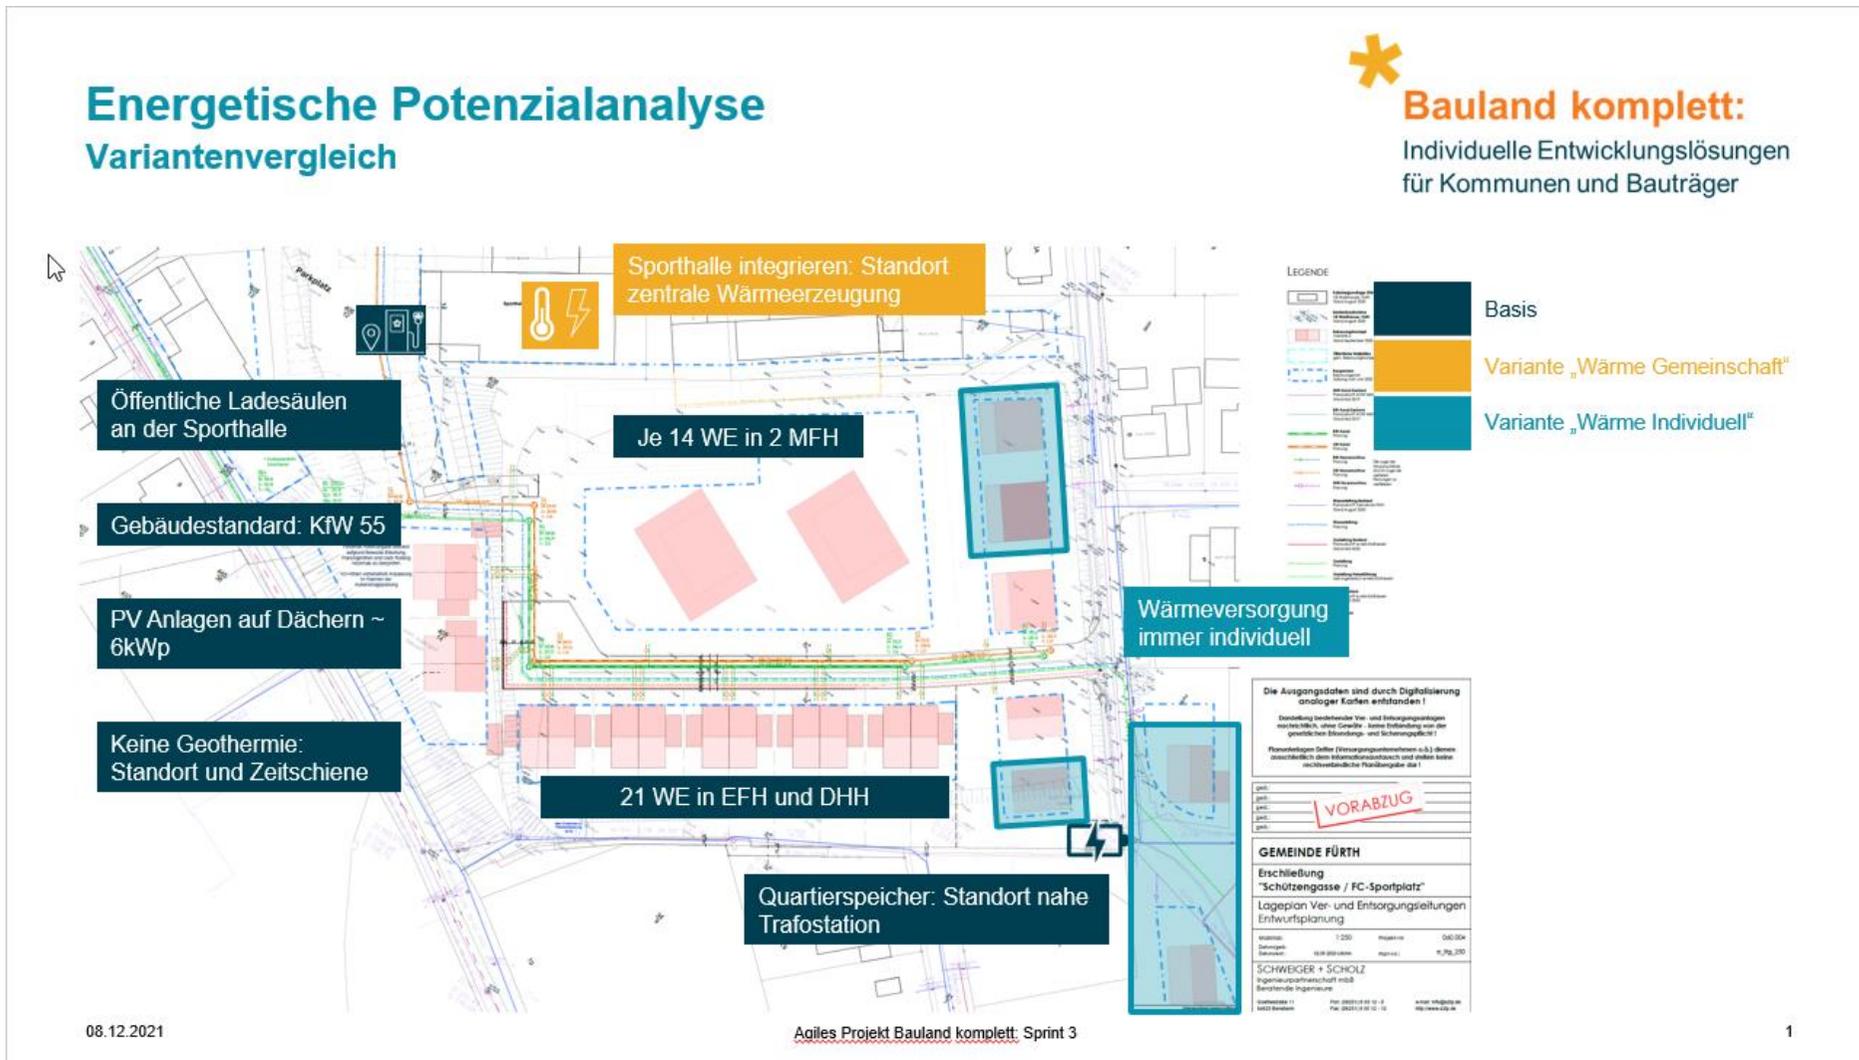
Gemeindebauliches Konzept „Schützengasse/ FC Sportplatz“ (Quelle: Gemeinde Fürth; Schwenger + Scholz & E-Netz-Südhessen, Stand: 02.09.2020)
